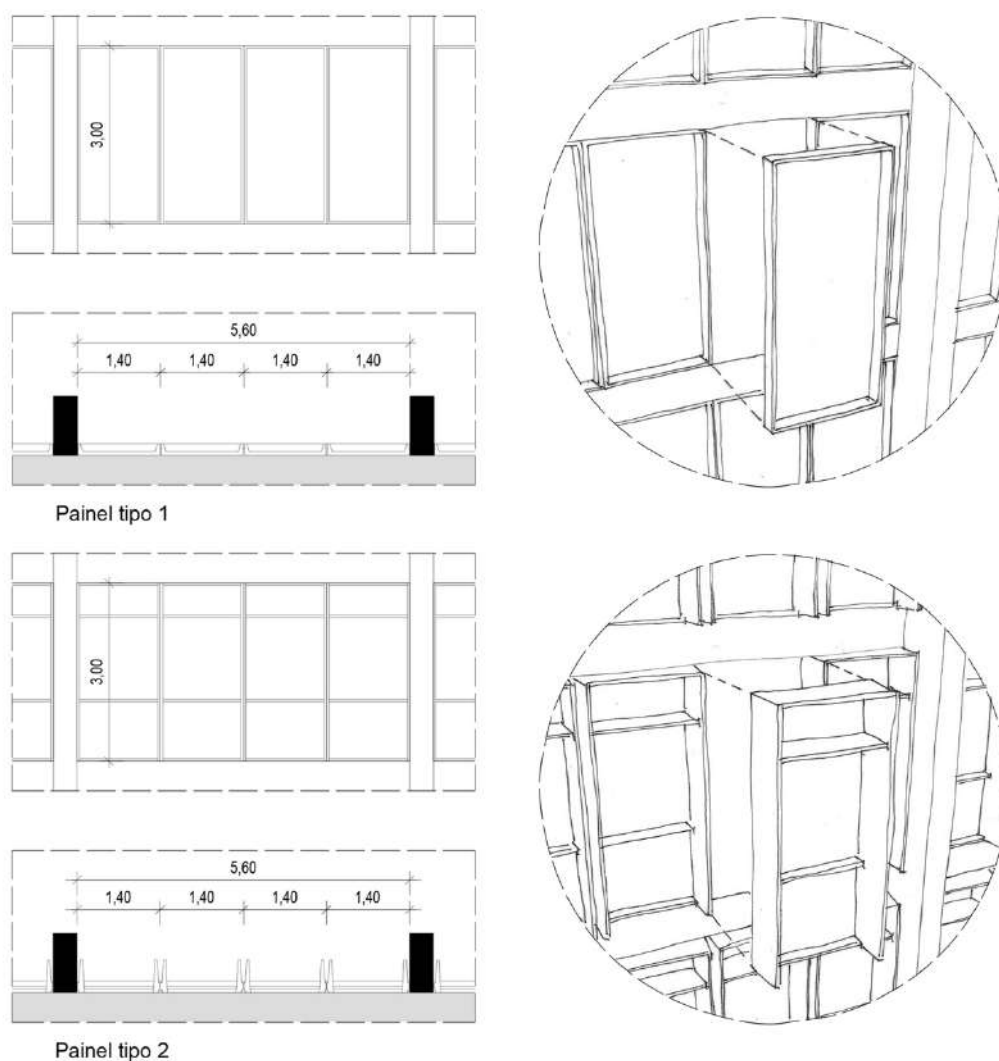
Detalhe dos painéis de vedação externa do Pavilhão João Lyra Filho.
